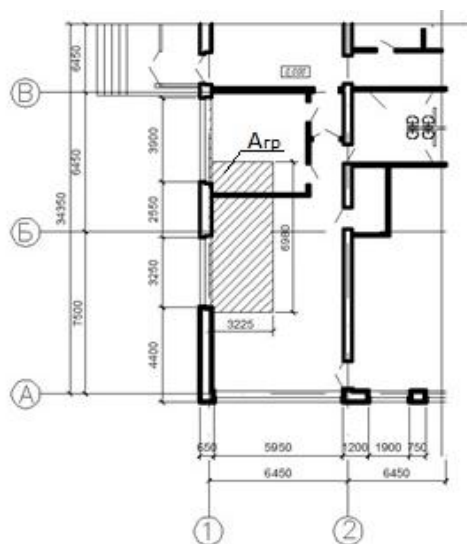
Фрагмент плана с указанием грузовой площади кирпичного простенка
